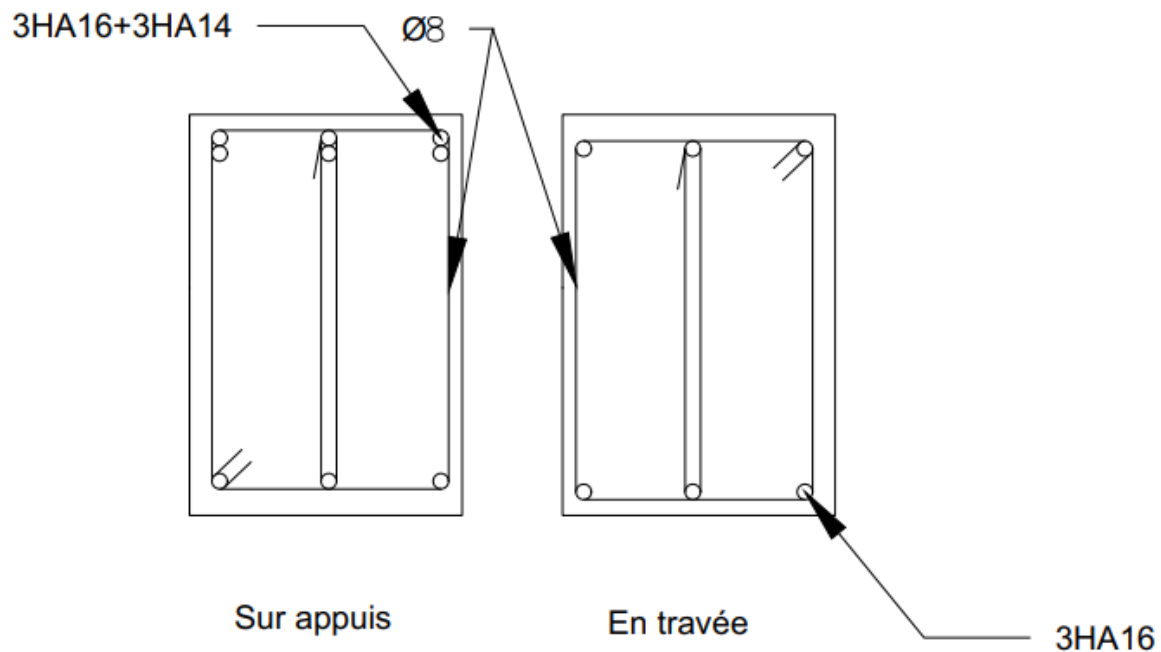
Ferrailage des poutres principales (étage commerce)
